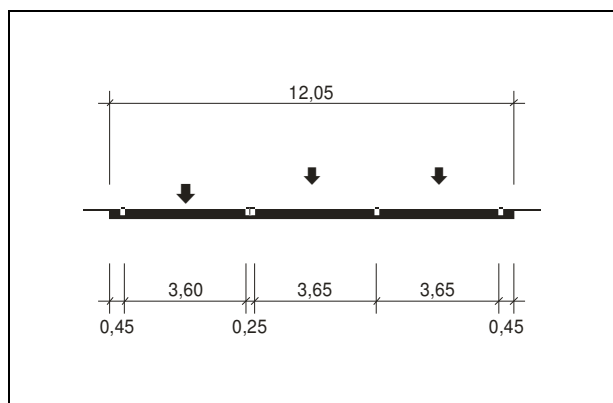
Querschnitt Untersuchungsstrecke 6, B 471 OU Dachau
